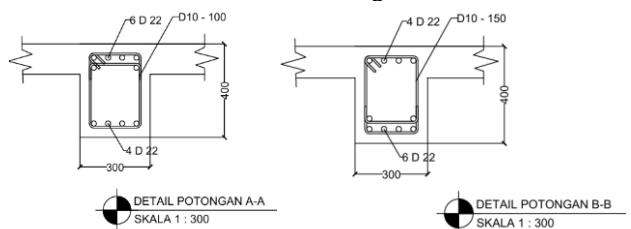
Potongan Penulangan Balok Induk Memanjang
